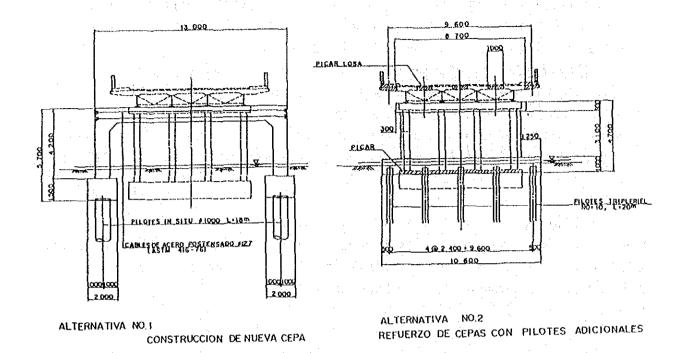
REPARACIONES DE LA INFRAESTRUCTURA DEL PUENTE RAMADILLAS
